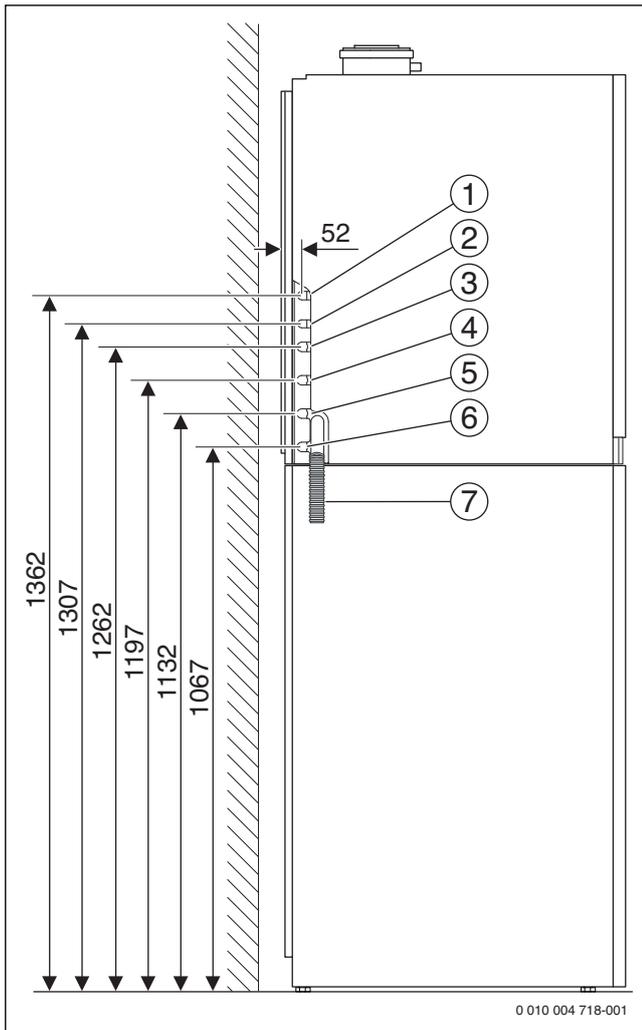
Anschlussmaße des Zubehörs AS-H1/Horizontales Anschluss-Set (Maße in mm)
